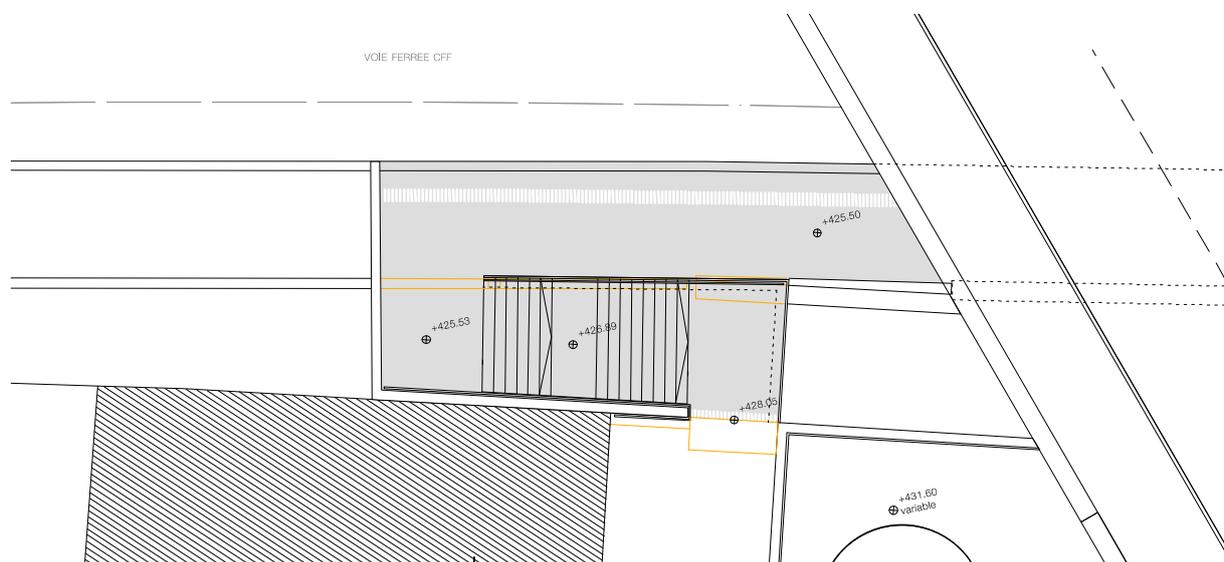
Accès Sud-Ouest _ vue en plan _ échelle : 1/200
